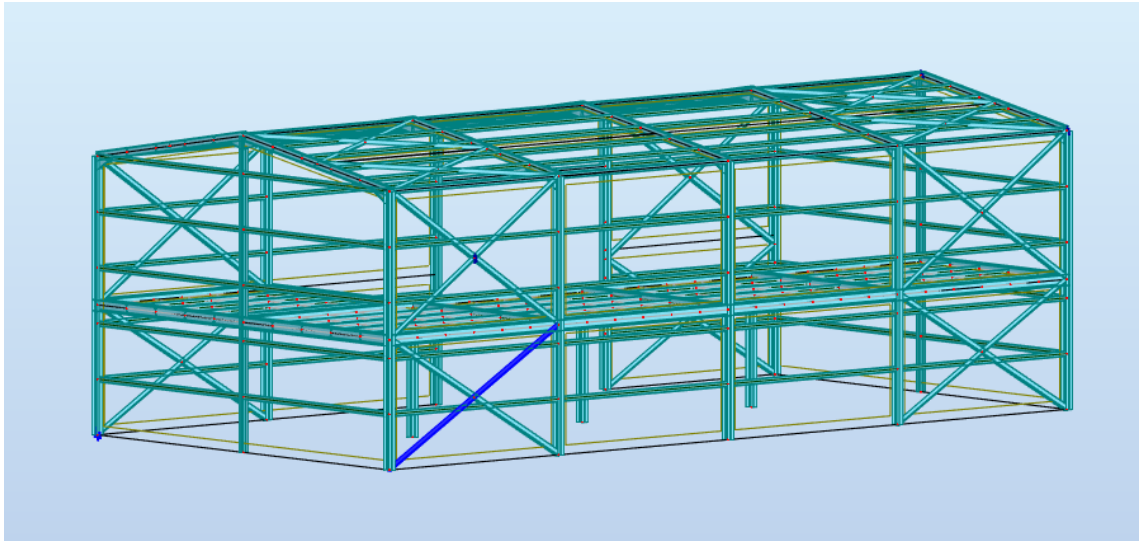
La diagonale de la poutre au vent la plus sollicitée
